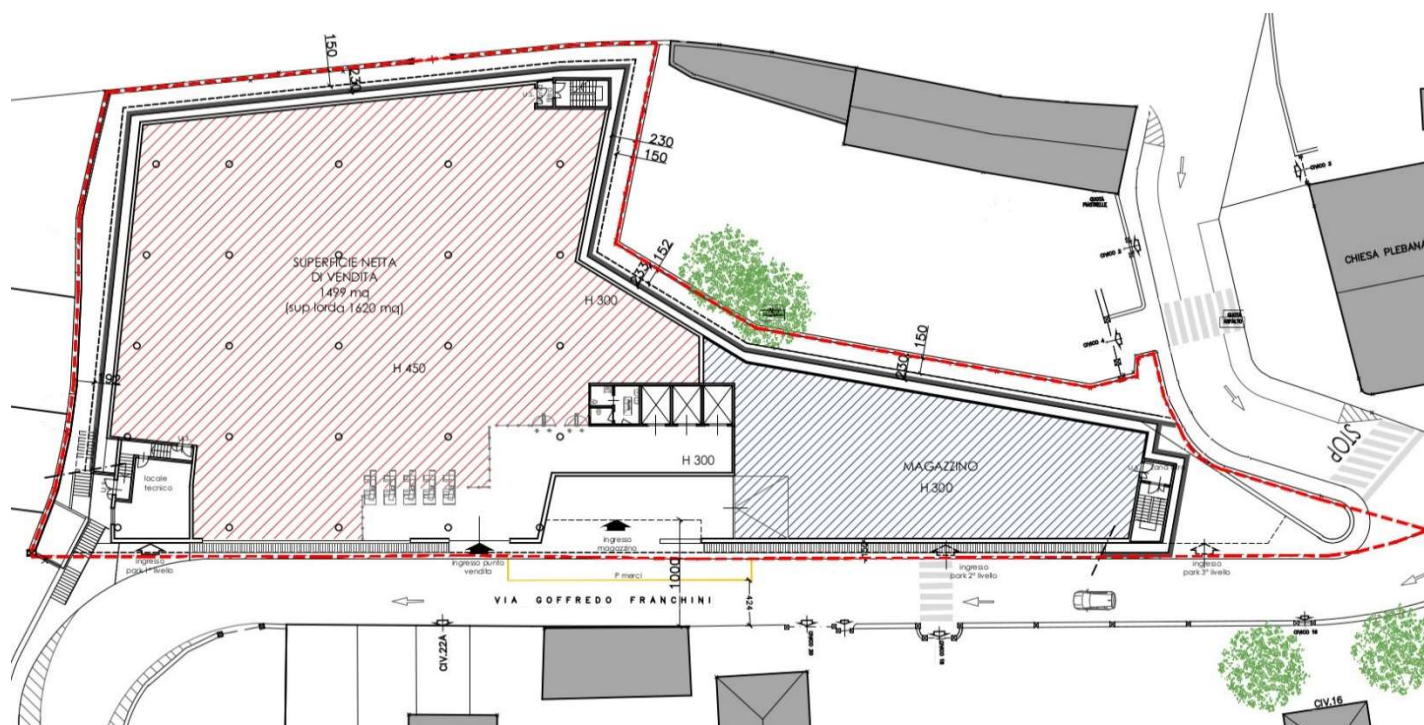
pianta nuova Media Struttura di Vendita e magazzino
